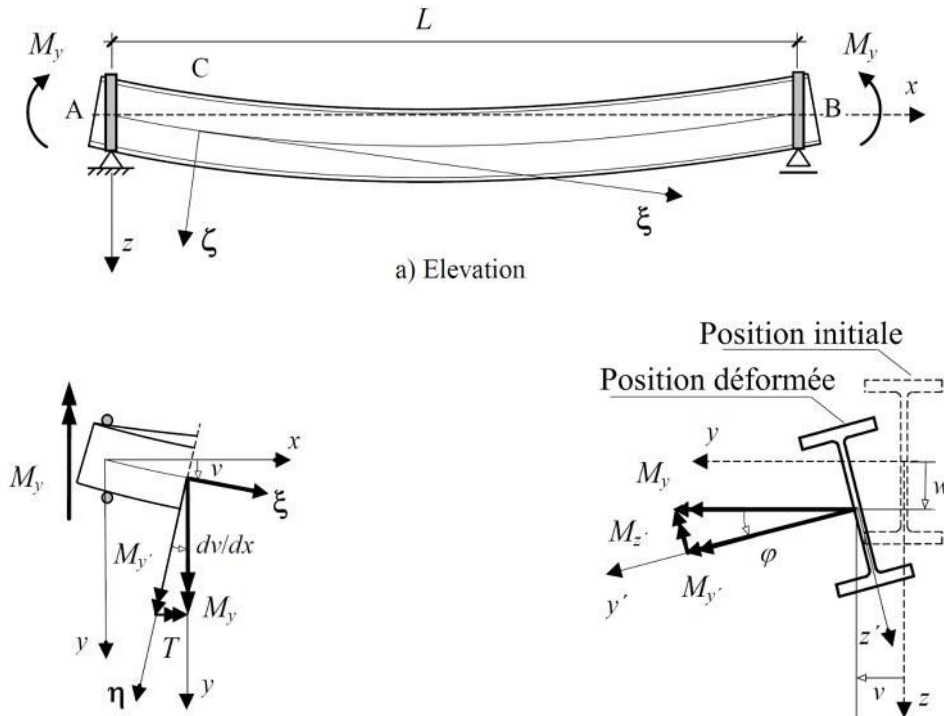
Déversement d'une poutre constituée d'une section en I bi-symétrique, sollicitée en flexion pure.
